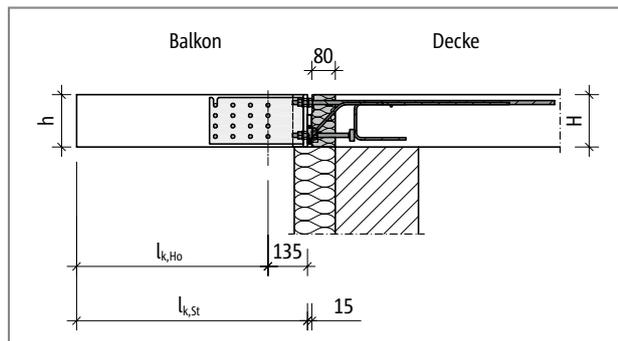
Schöck Isokorb® T Typ SK mit Stahlschwert: Statisches System
